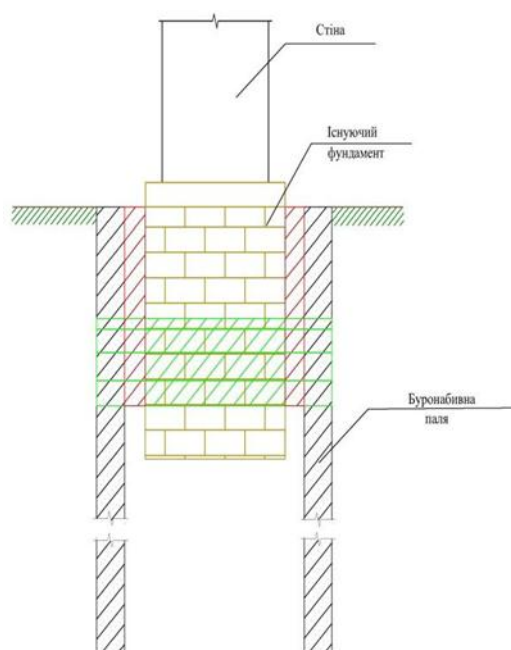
Схема розподілу навантаження від будівлі до буронабивних паль
